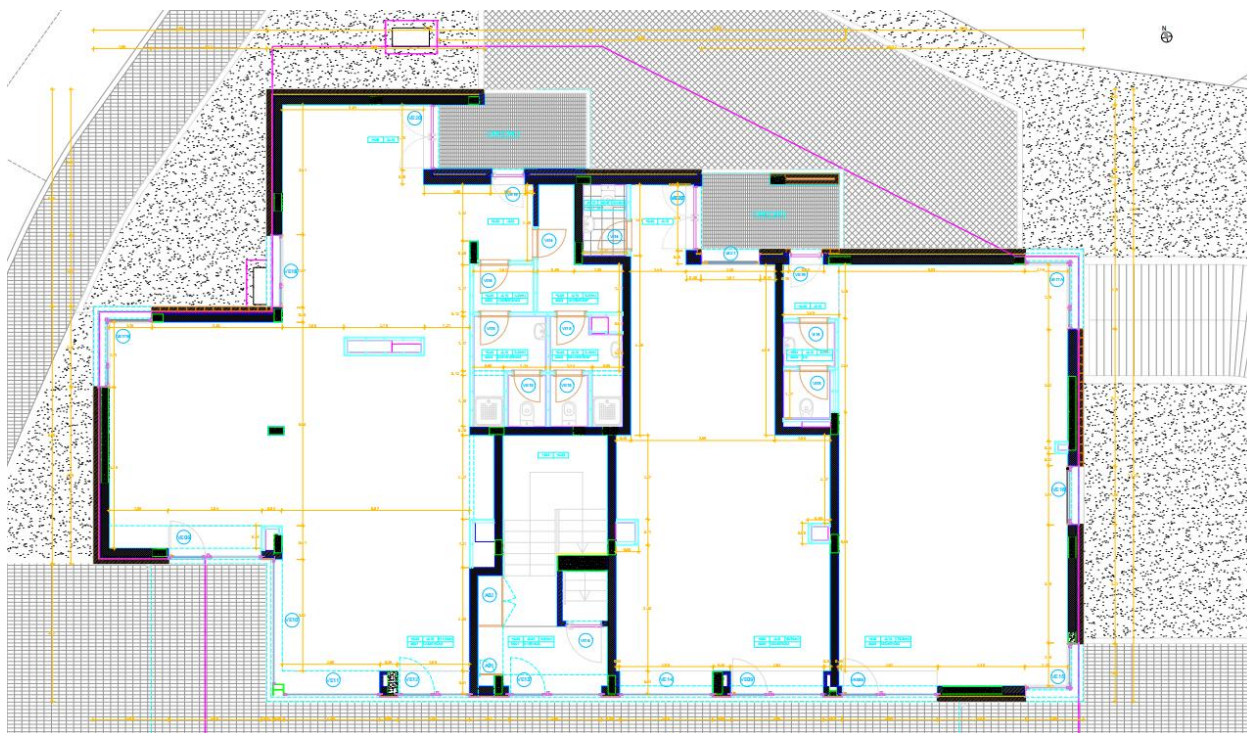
Planta R/Ch (FONTE: Ficheiro AutoCad – projeto de arquitetura)
